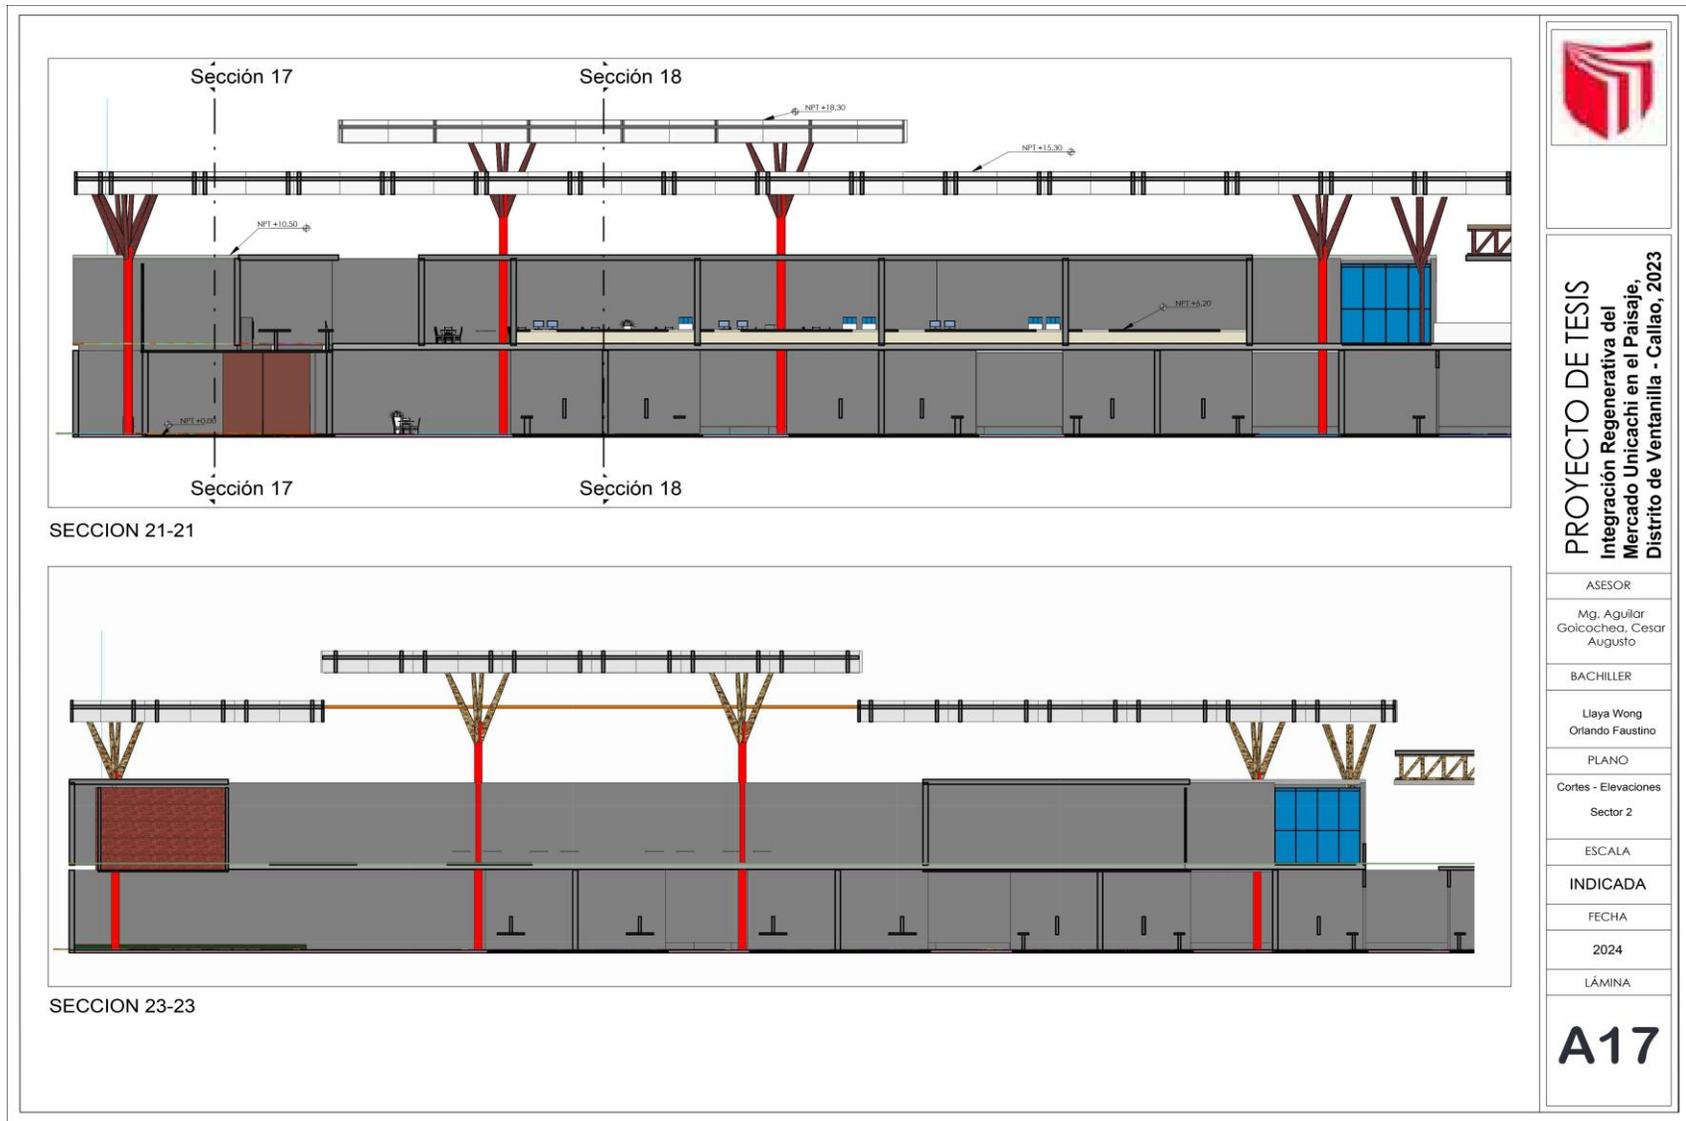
Plano de Cortes elevaciones de sector II – Plano I, elaboración propia.
